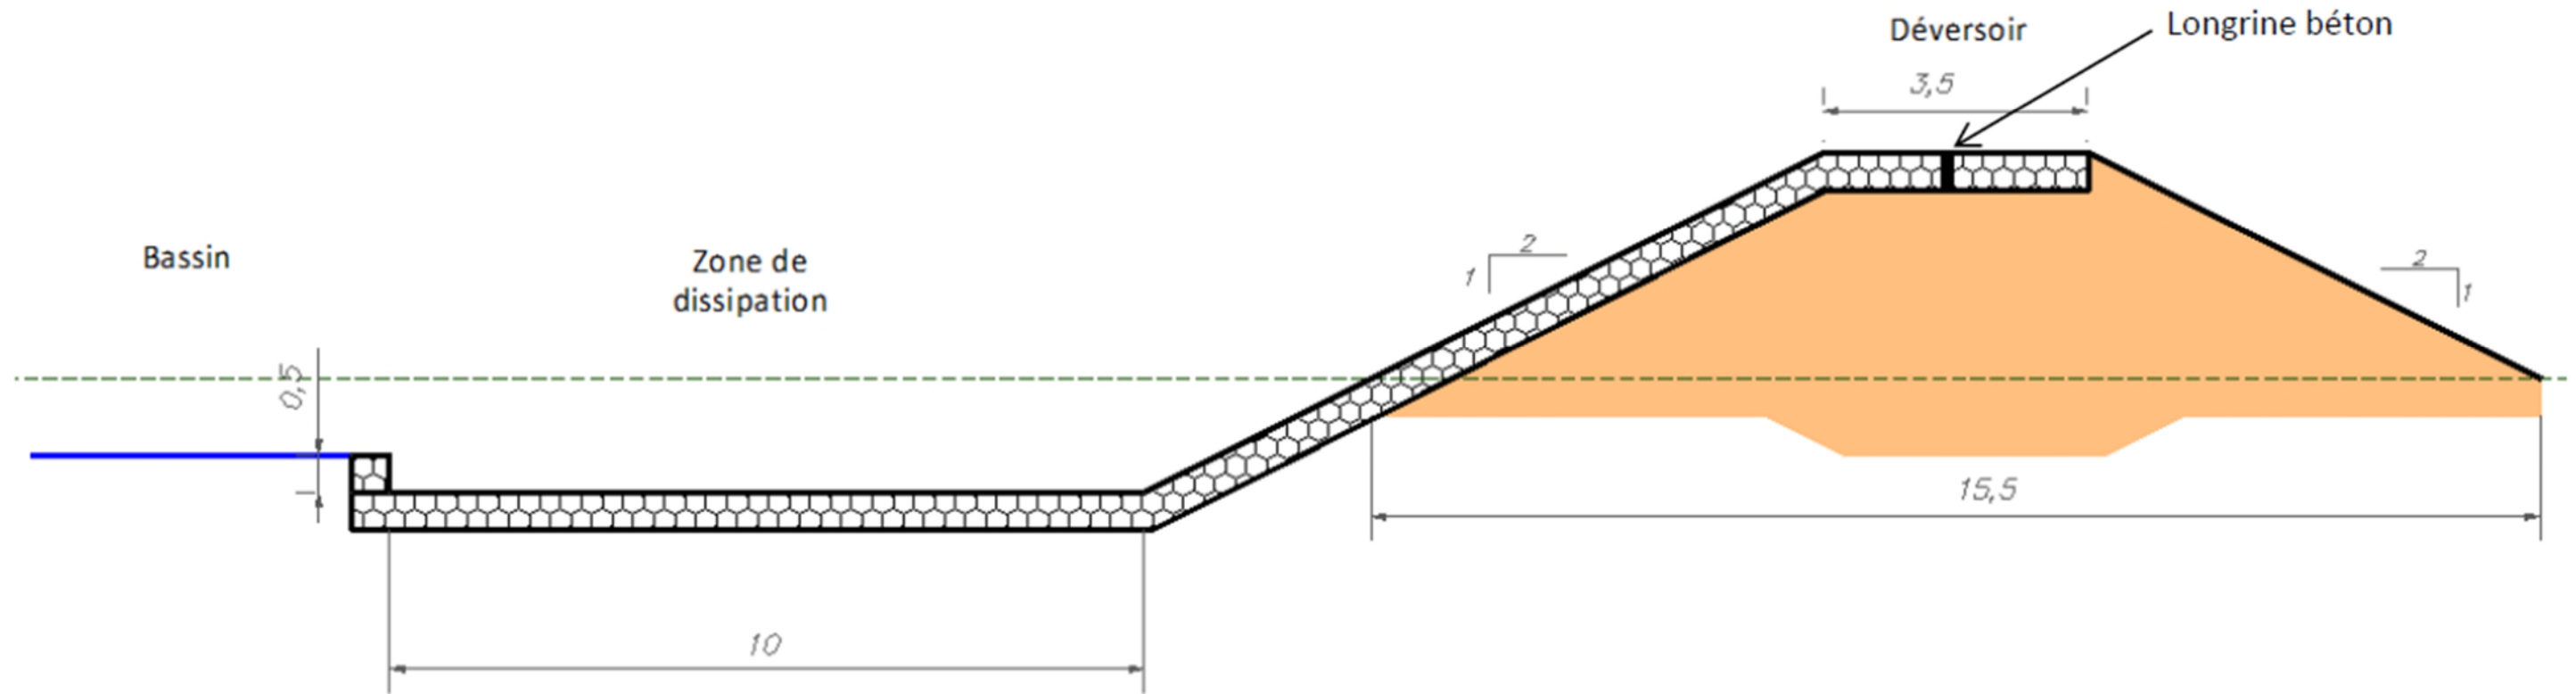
COUPE TYPE AU DROIT DU DÉVERSOIR
